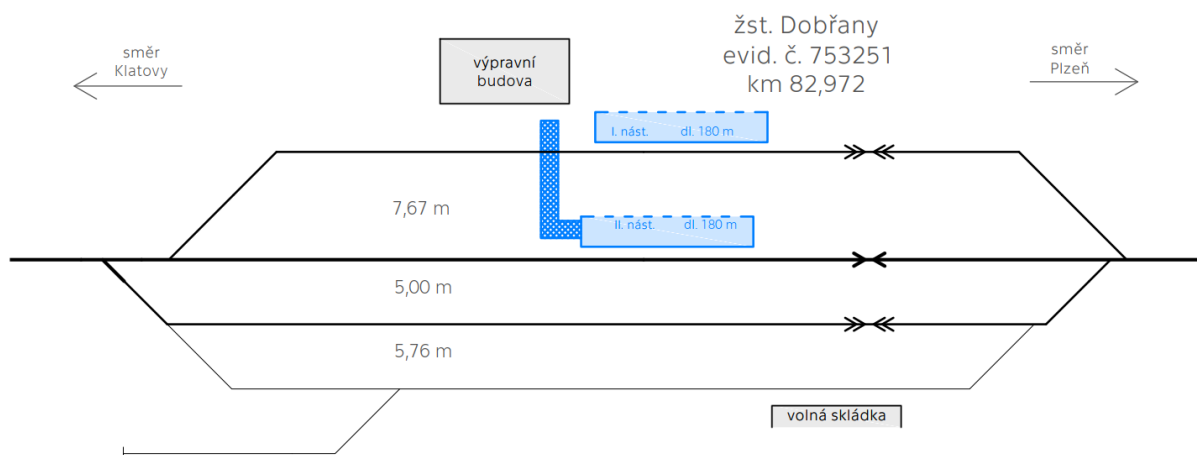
Dopravní schéma žst. Dobřany – varianta B
